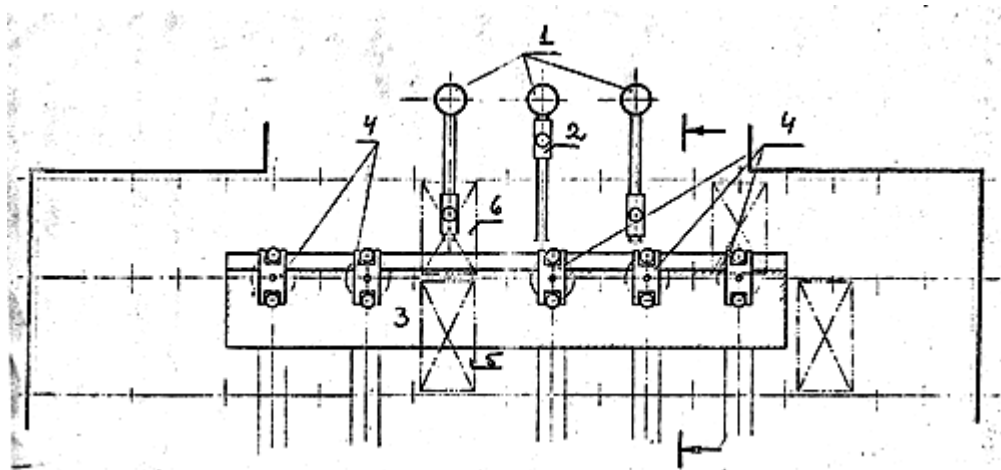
Линейное расположение МНЛЗ с разливкой стали с поворотных стенов. План: 1 — конвертер, 2 — сталевазная тележка, 3 — МНЛЗ, 4 — поворотный сталеразливочный стенд, 5 — мостовой кран, 6 — мостовой разливочный кран
